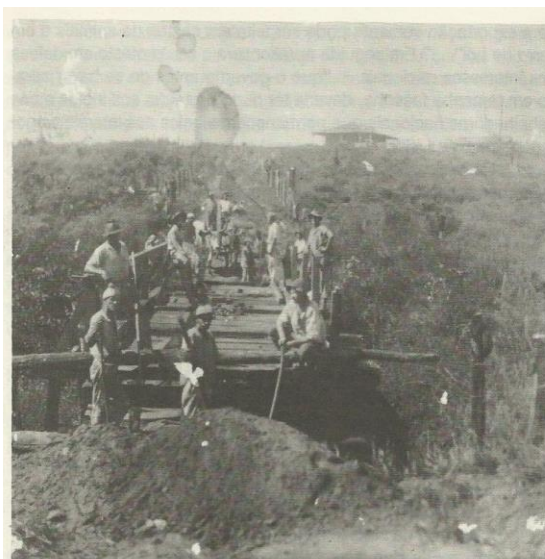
Foto da construção da ponte sobre que dá acesso a Colônia Uvá.
